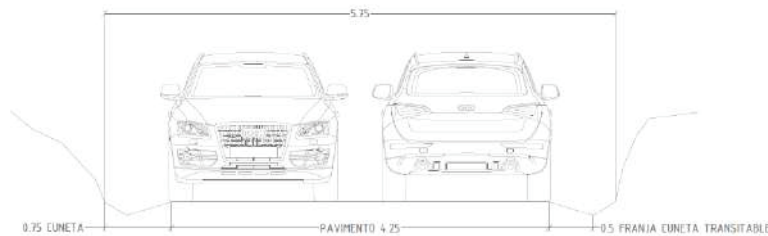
Sección de la propuesta de camino de acceso
